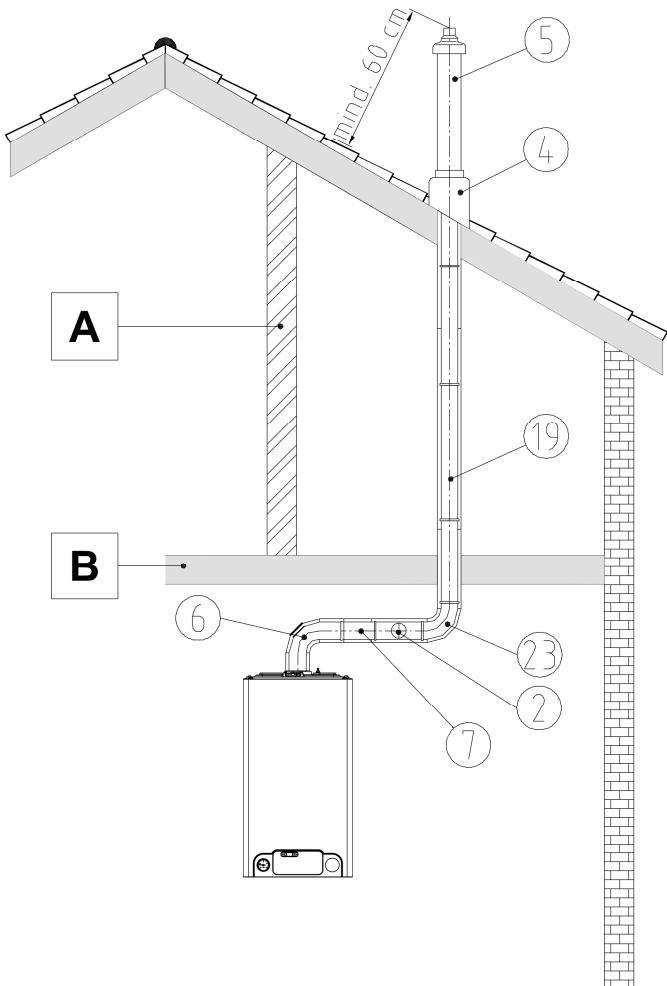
C_{33X} Dachheizzentrale mit Luft-Abgas-Rohrsystem senkrecht durch eine Decke und eine Dachhaut
